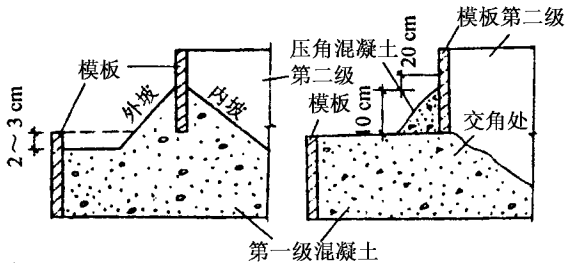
台阶式柱基础交角处浇筑方法示意
